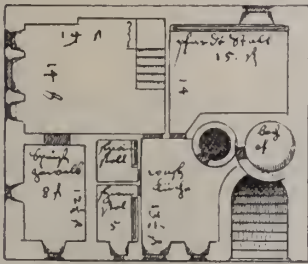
Grundriß des Erdgeschoßes. Fig. 114. Grundriß des ersten Obergeschoßes.
